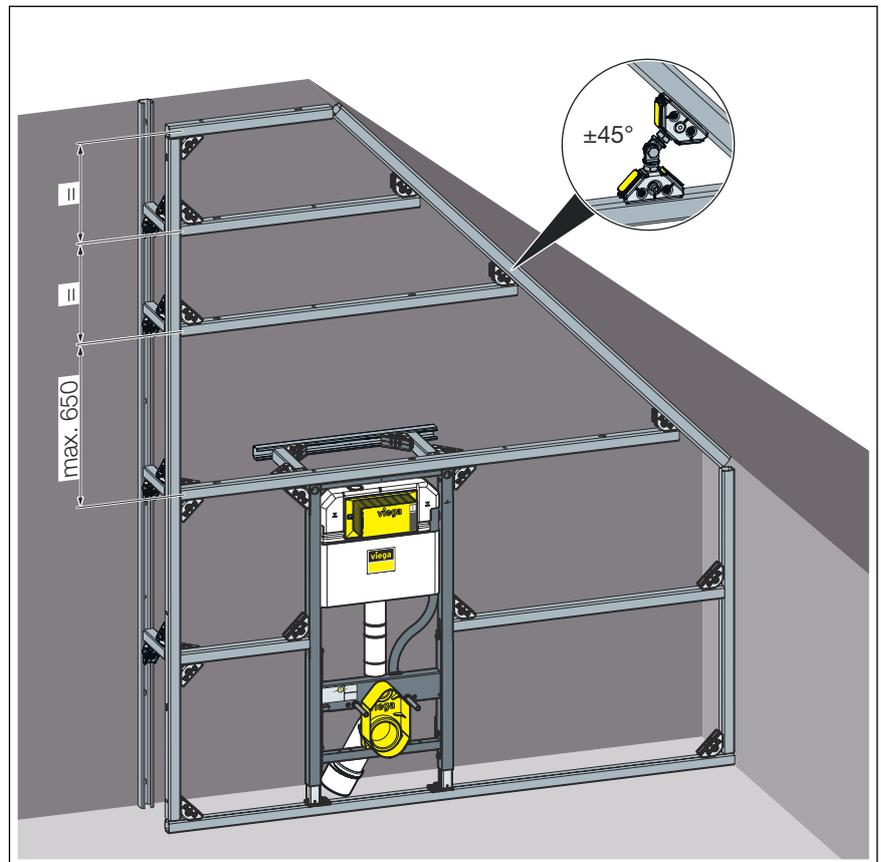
Cotes de montage, cloison sur le pan du toit
